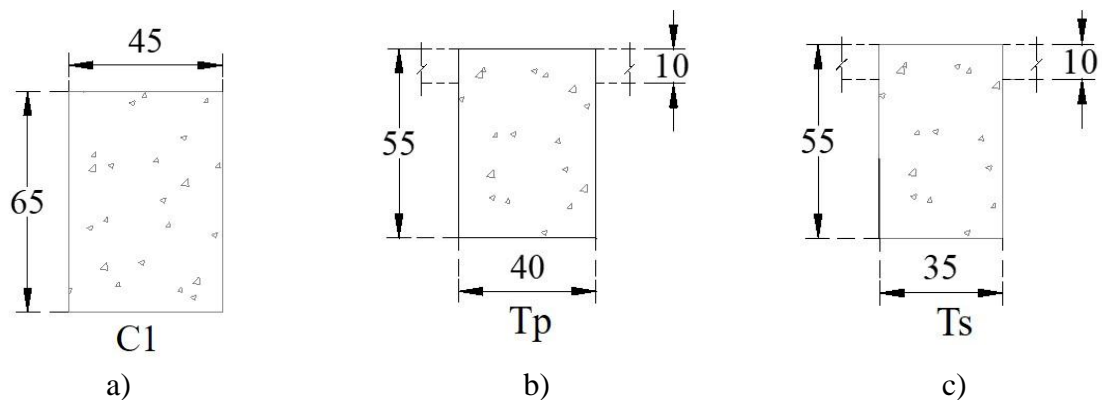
Elementos estruturais de concreto do EA; a) Pilares (C1); b) vigas principais (Tp); c) vigas secundárias (Ts). Cotas em cm.
